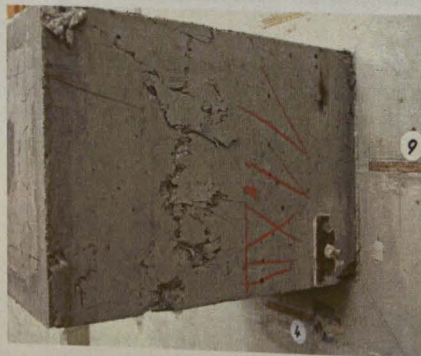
Versagensbild des einbetonierten Stützenstummel
